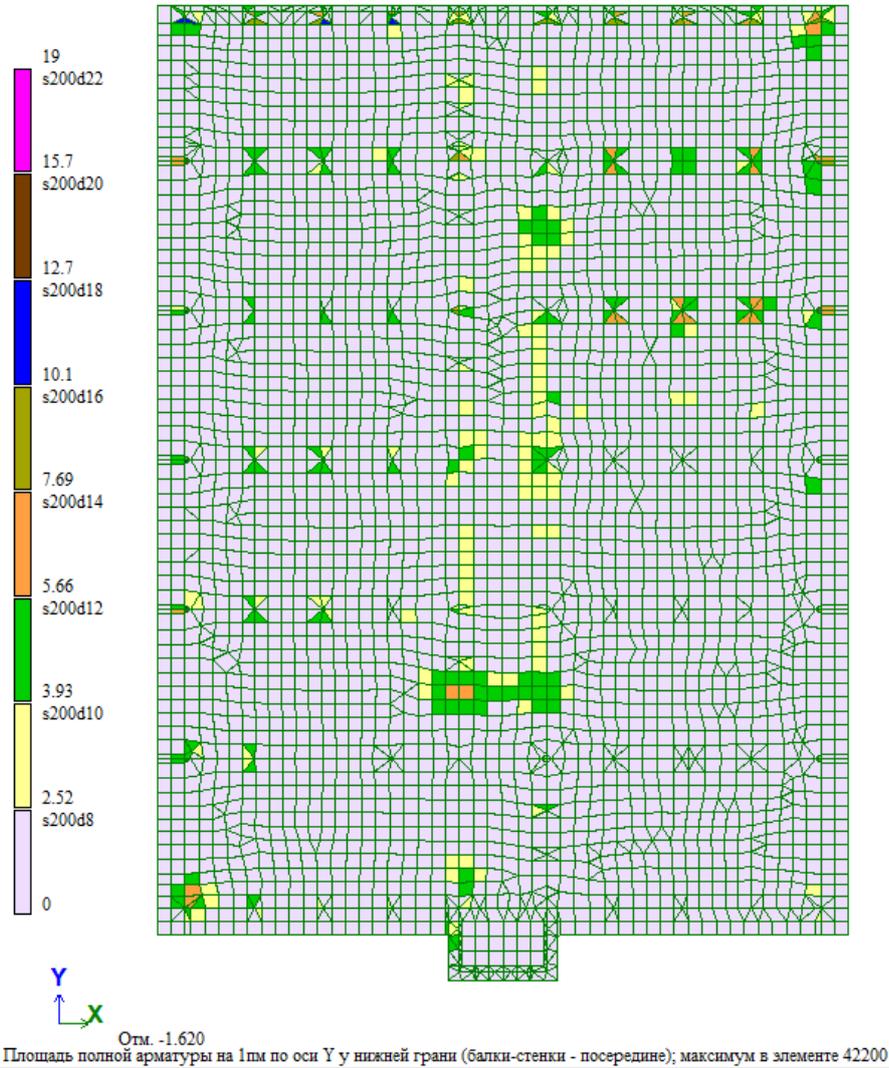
Площадь арматуры на 1 м по оси Y у нижней грани
